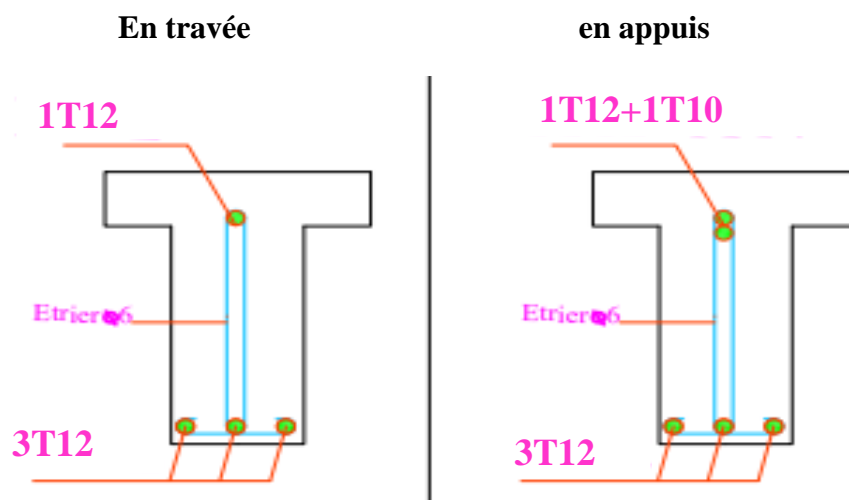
Schémas de ferrailage des poutrelles étage courant
